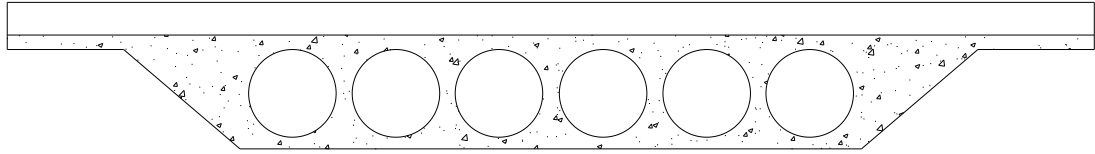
Sección transversal de puente con losa aligerada de concreto reforzado colado in situ (Villarino Otero, 2010).
